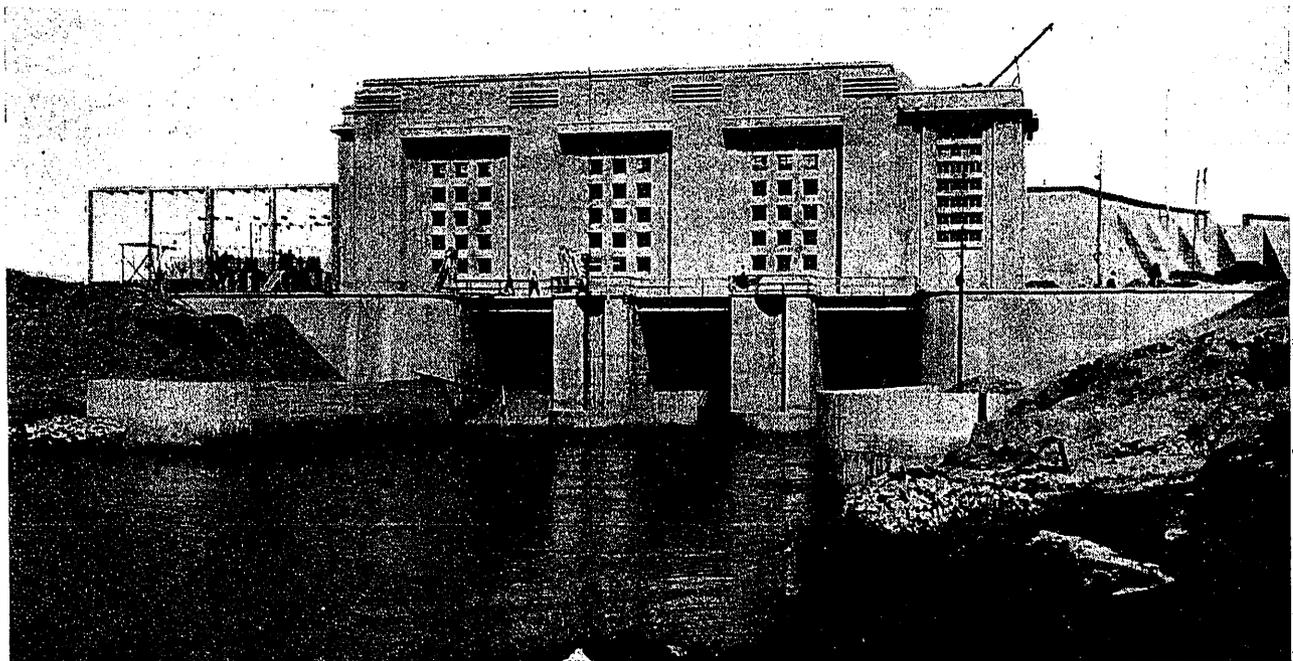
Vista de la Central, canal de descarga y Subestación.
